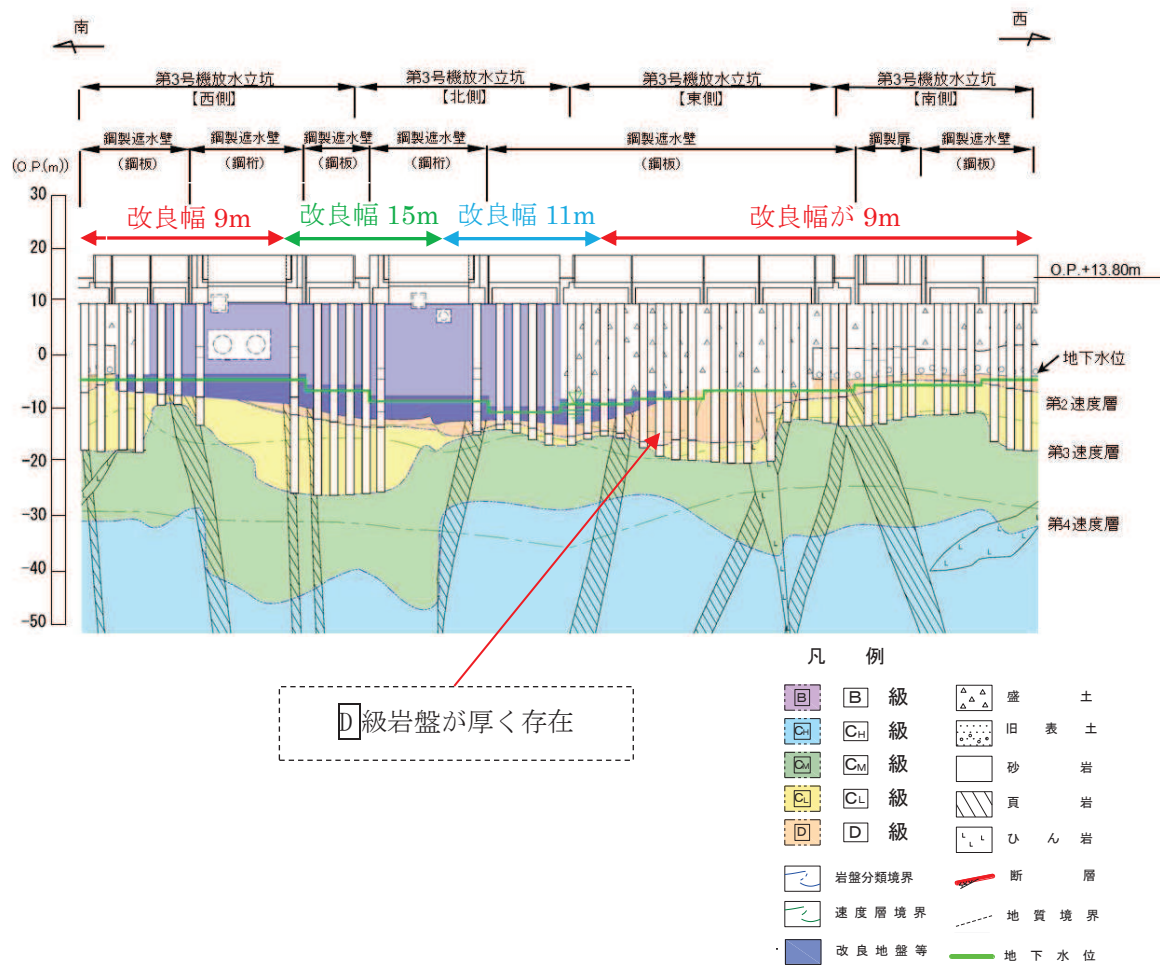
第 3 号機放水立坑防潮壁部 地質縦断面図
